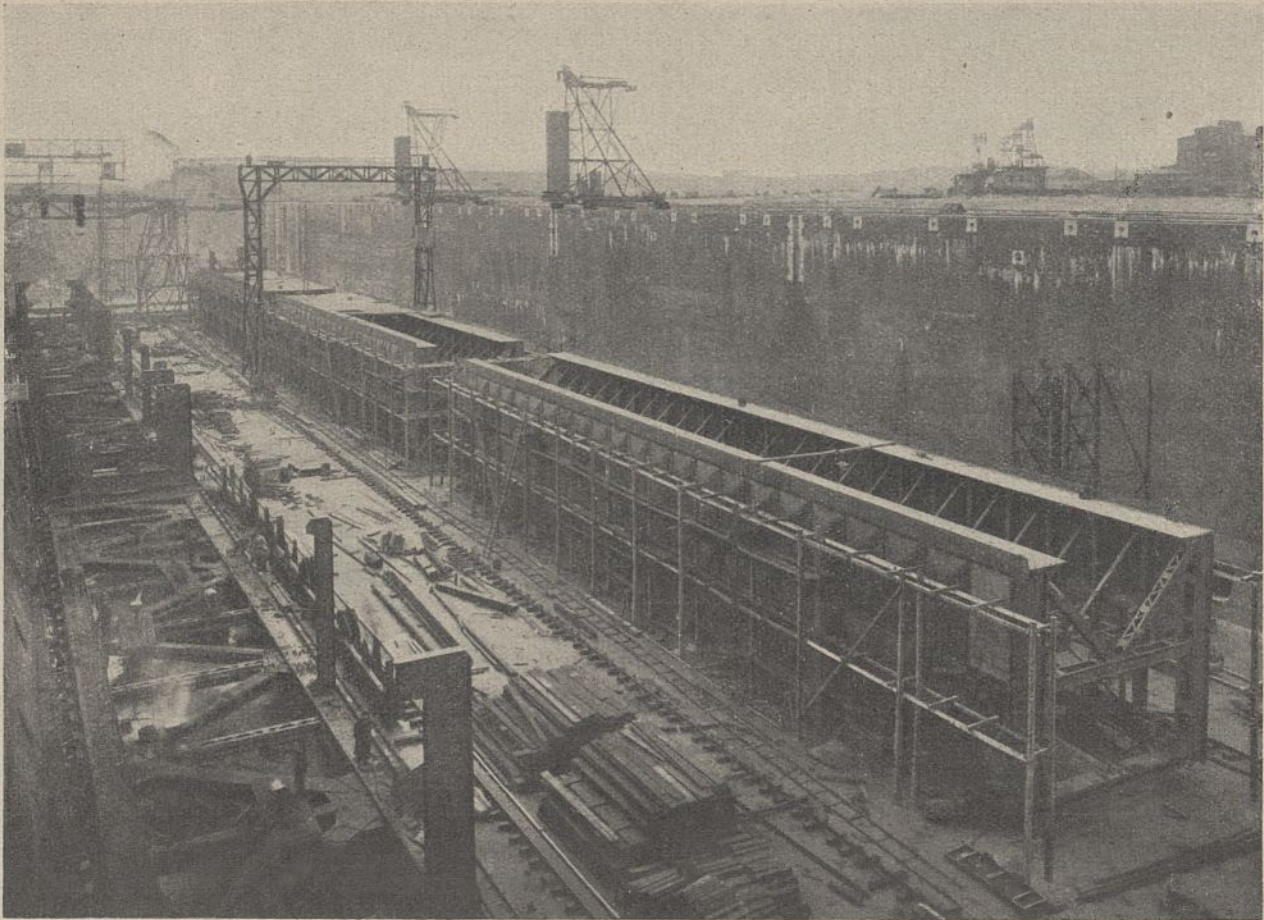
Bau der 6 Schiebetore der neuen Schleusen Holtenau in einer Schleusen-kammer.
